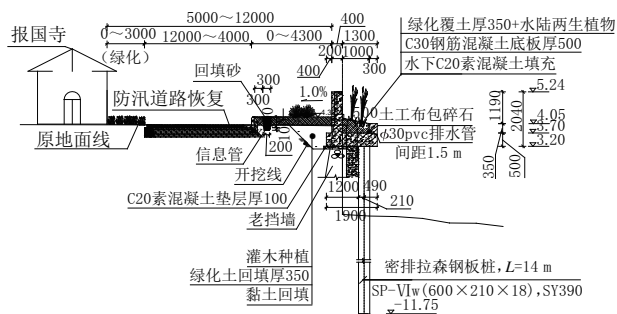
高桩承台贴壁加固典型断面(尺寸单位:mm;高程单位:m)
